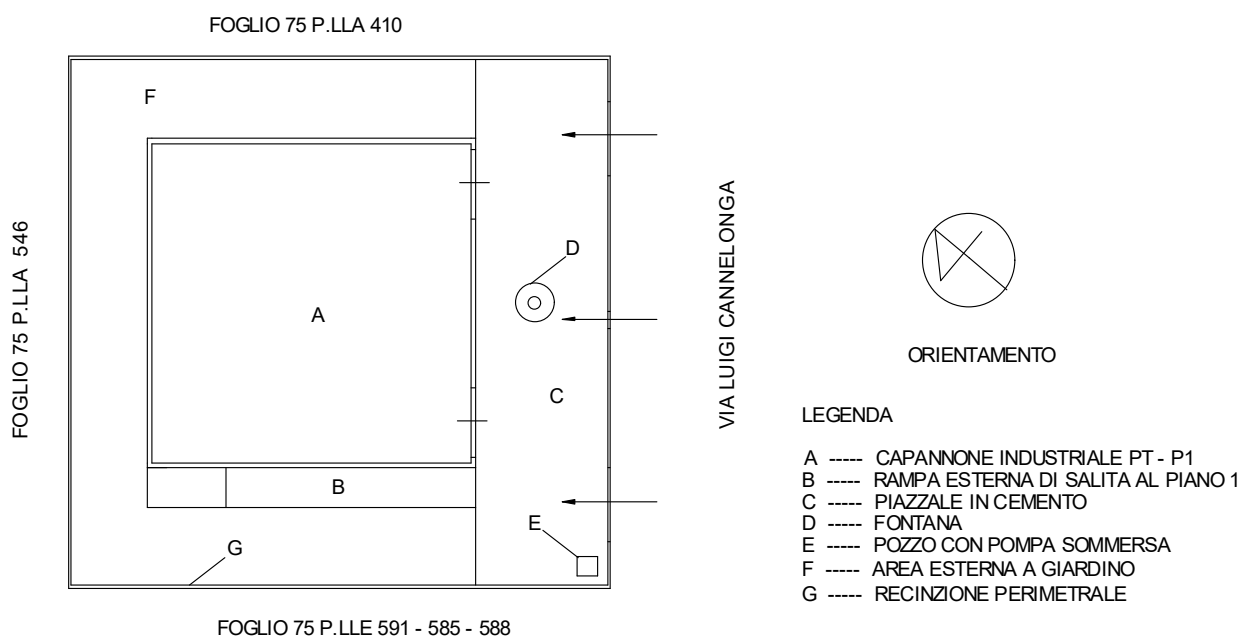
Planimetria generale del complesso edilizio adibito a laboratorio artigianale sito in San Severo alla via Luigi Cannelonga n° 17.
